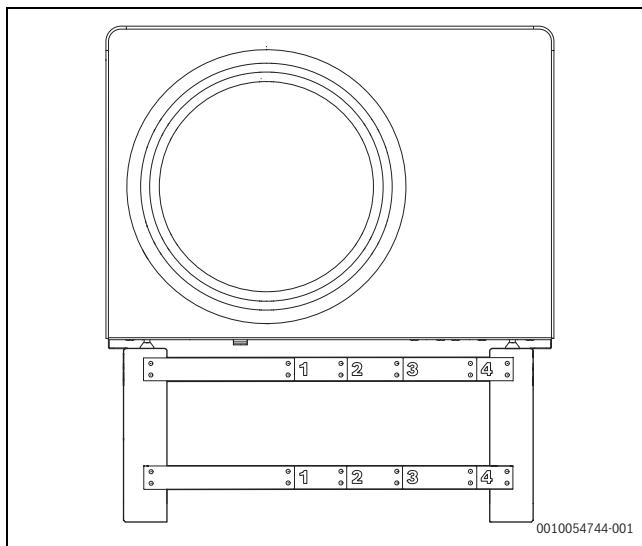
Příklad instalace: Prefabrikovaný základ v zemi
